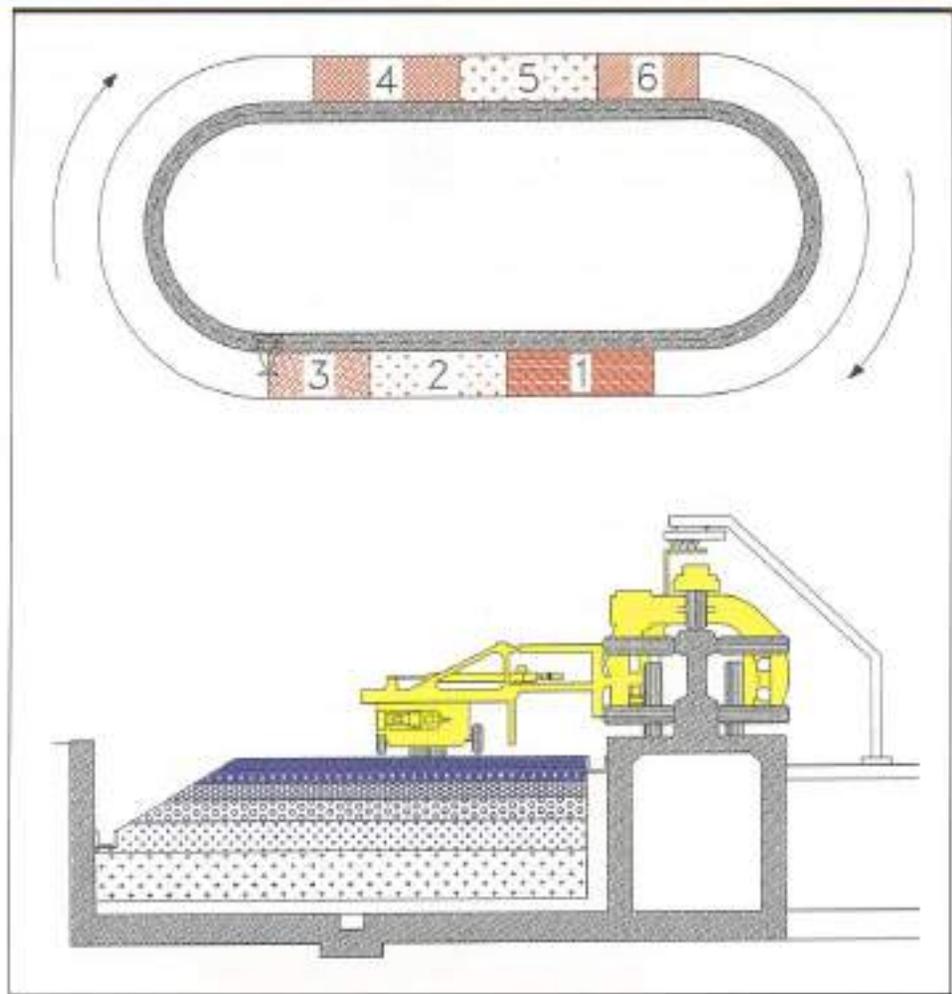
Plano y sección transversal de la pista de ensayo.
